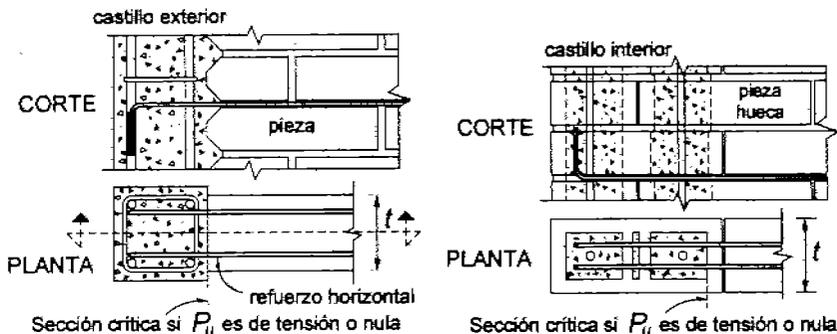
ANCLAJE DE REFUERZO HORIZONTAL
